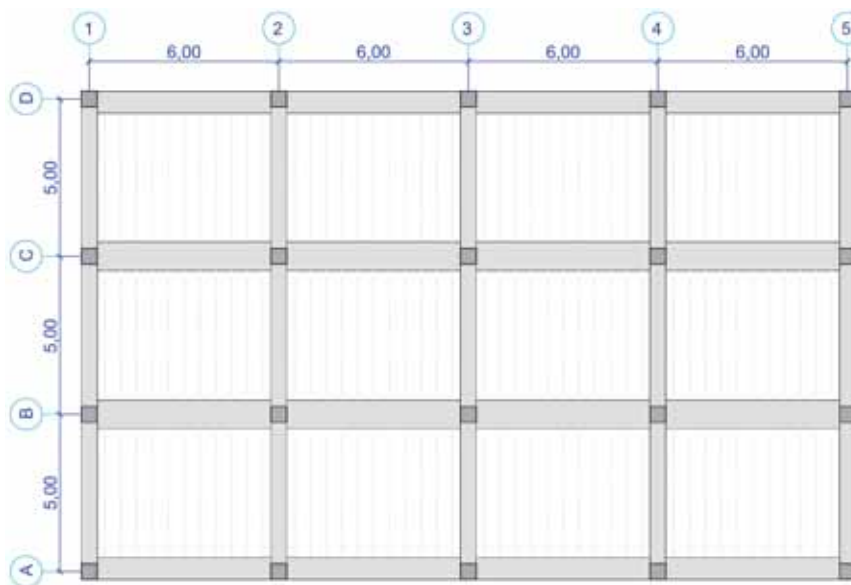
Planta típica del edificio con vigas planas (igual en todos los niveles).
